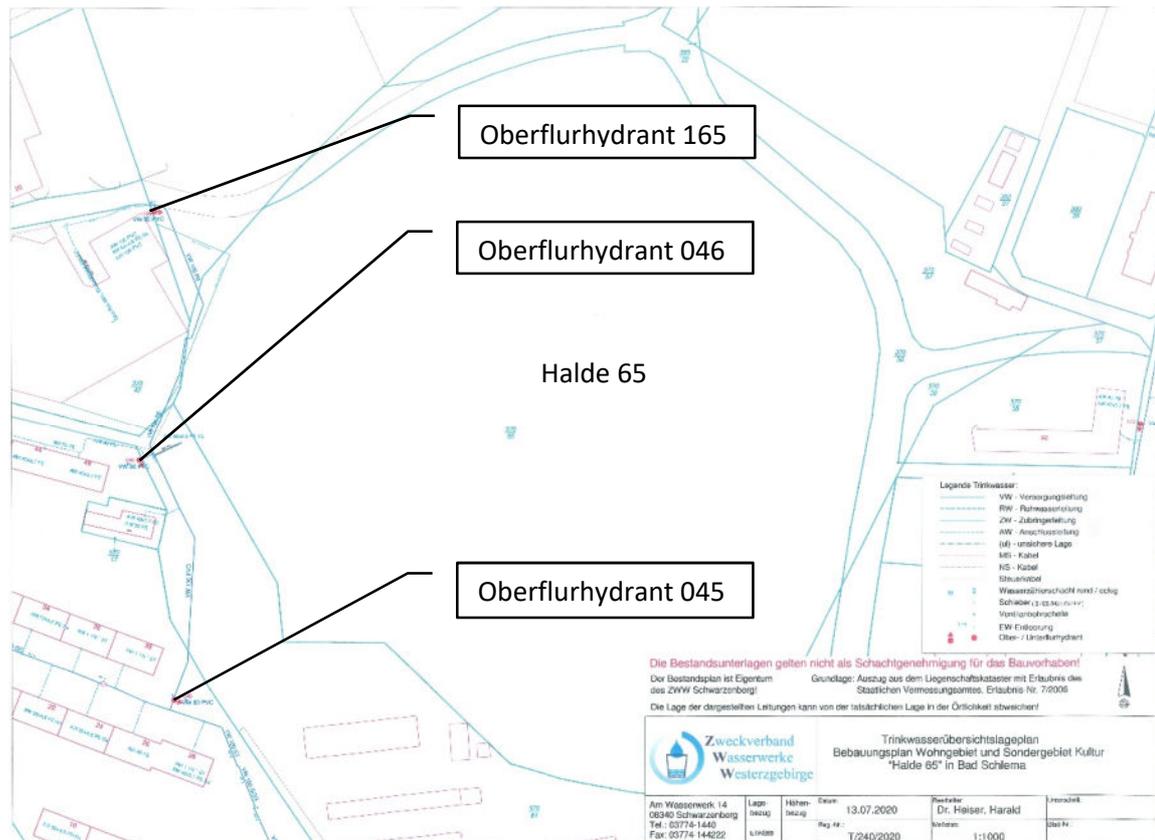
Lageplan Trink- und Löschwasser ZWW [7]
